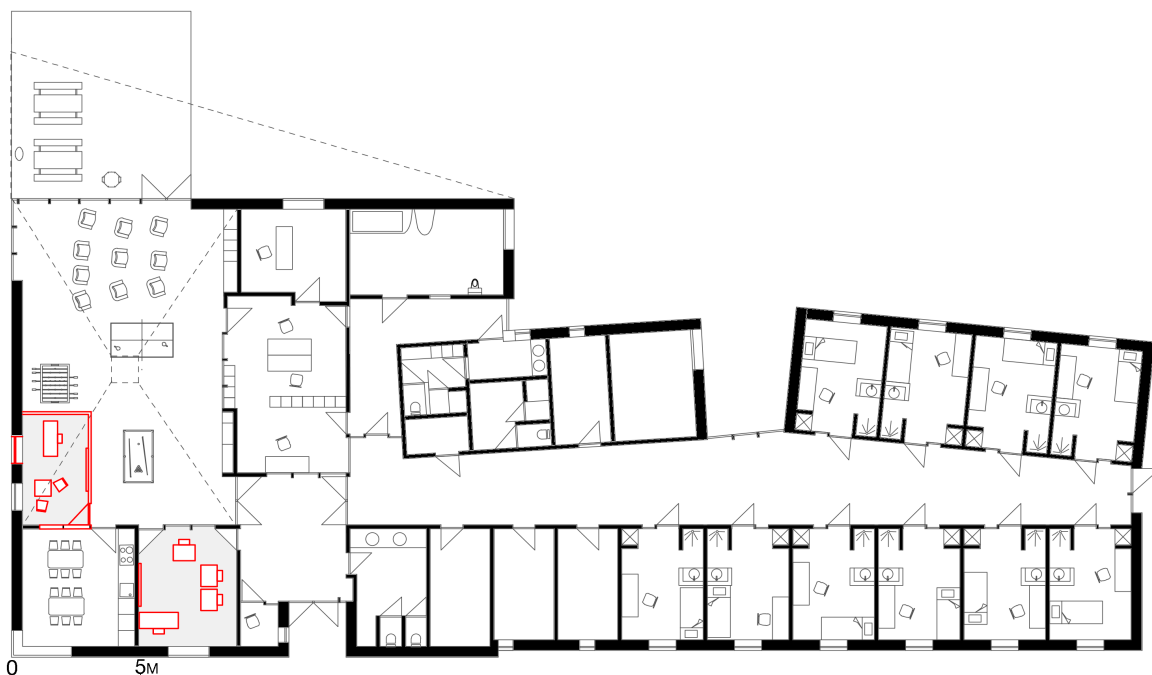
Seconde proposition de plan schématique pour la piste 2
